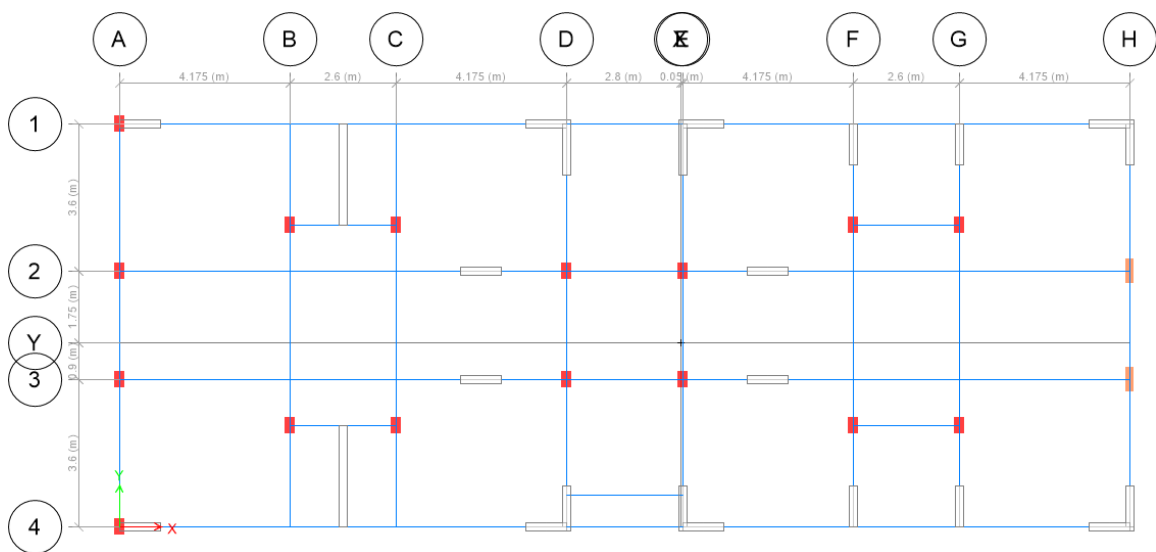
Planta de Estructuración modelado en el software ETABS V16.2.1
